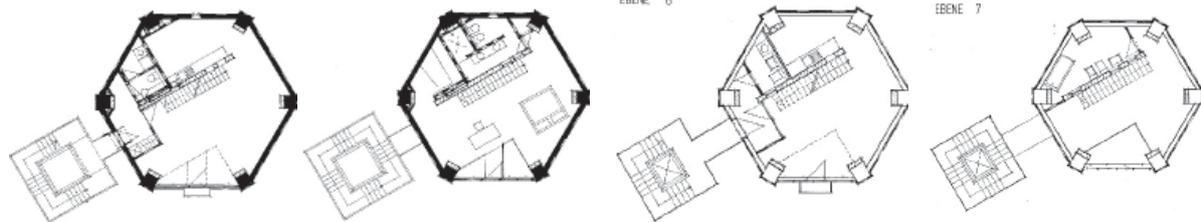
Grundrisse Ebene 2, 3, 6 und 7
